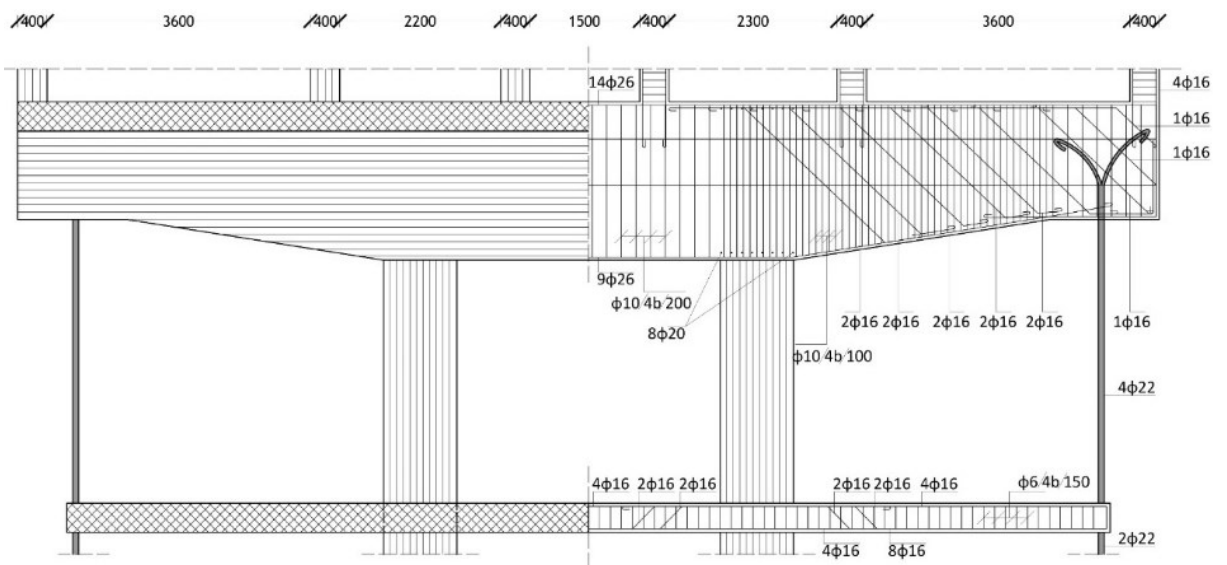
Ricostruzione del disegno di progetto della trave a doppio sbalzo in calcestruzzo armato situata all'ingresso dell'Unità 2
